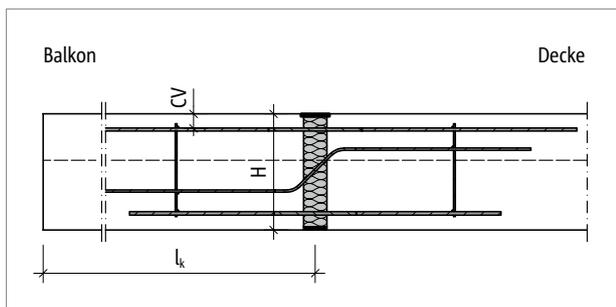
Schöck Isokorb® T Typ B: Statisches System
